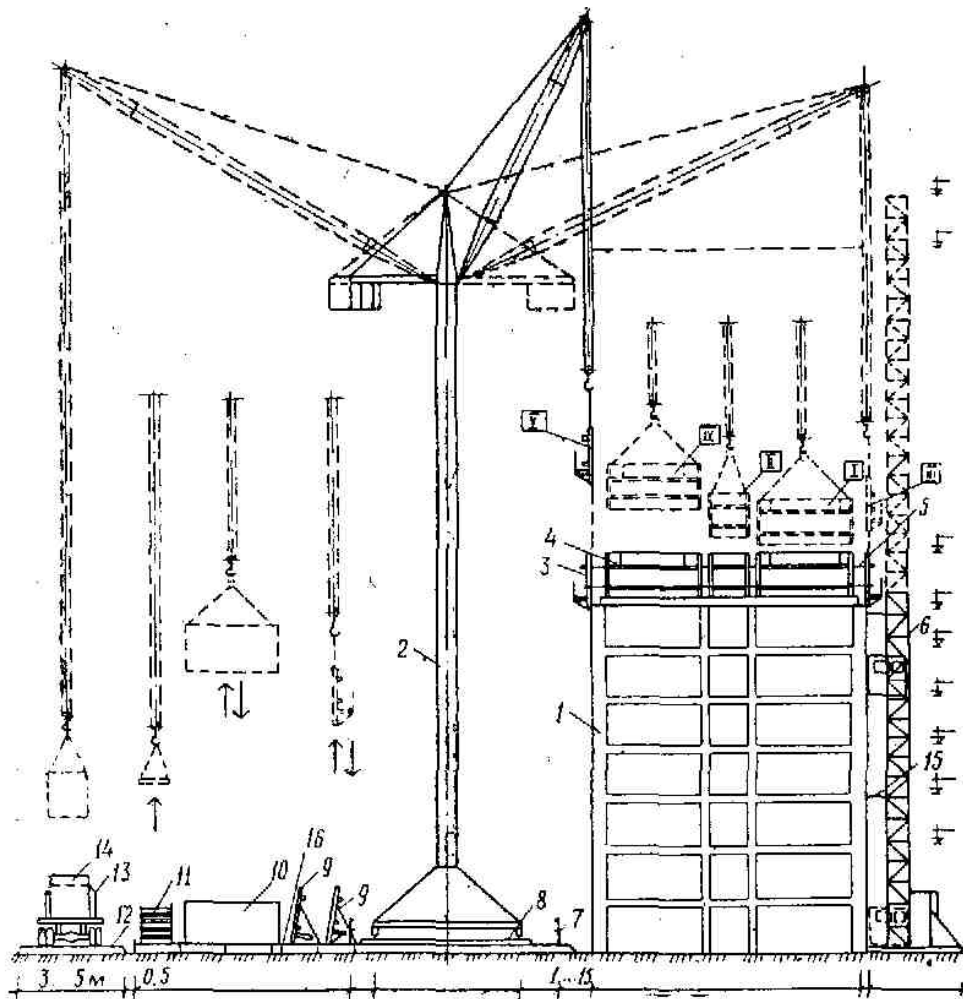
Схема улаштування опалубки під час зведення багатоповерхового будинку:
